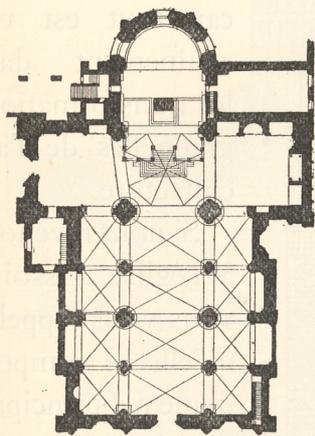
Église Saint-Michel, à Pavie. Plan.
